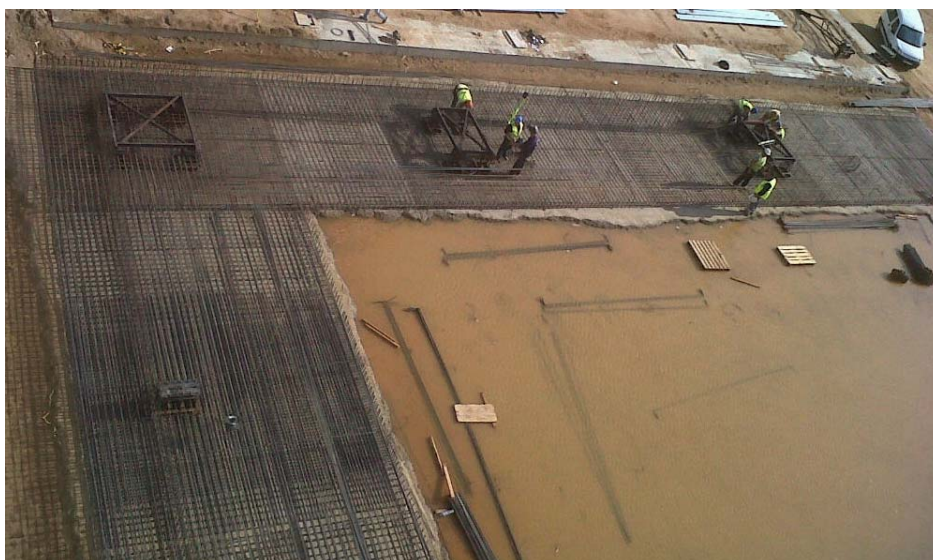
PLANTA DE CIMENTACION EN EJEUCIÓN
